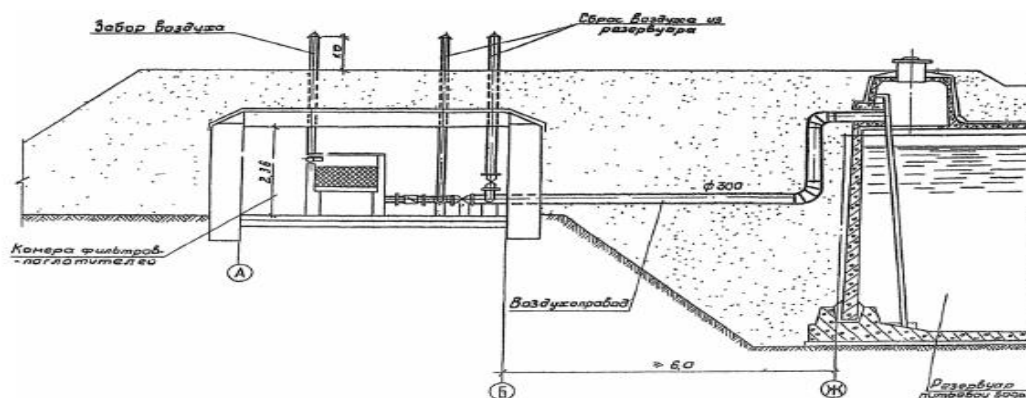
Пример расположения камеры ФП и резервуара [8].
